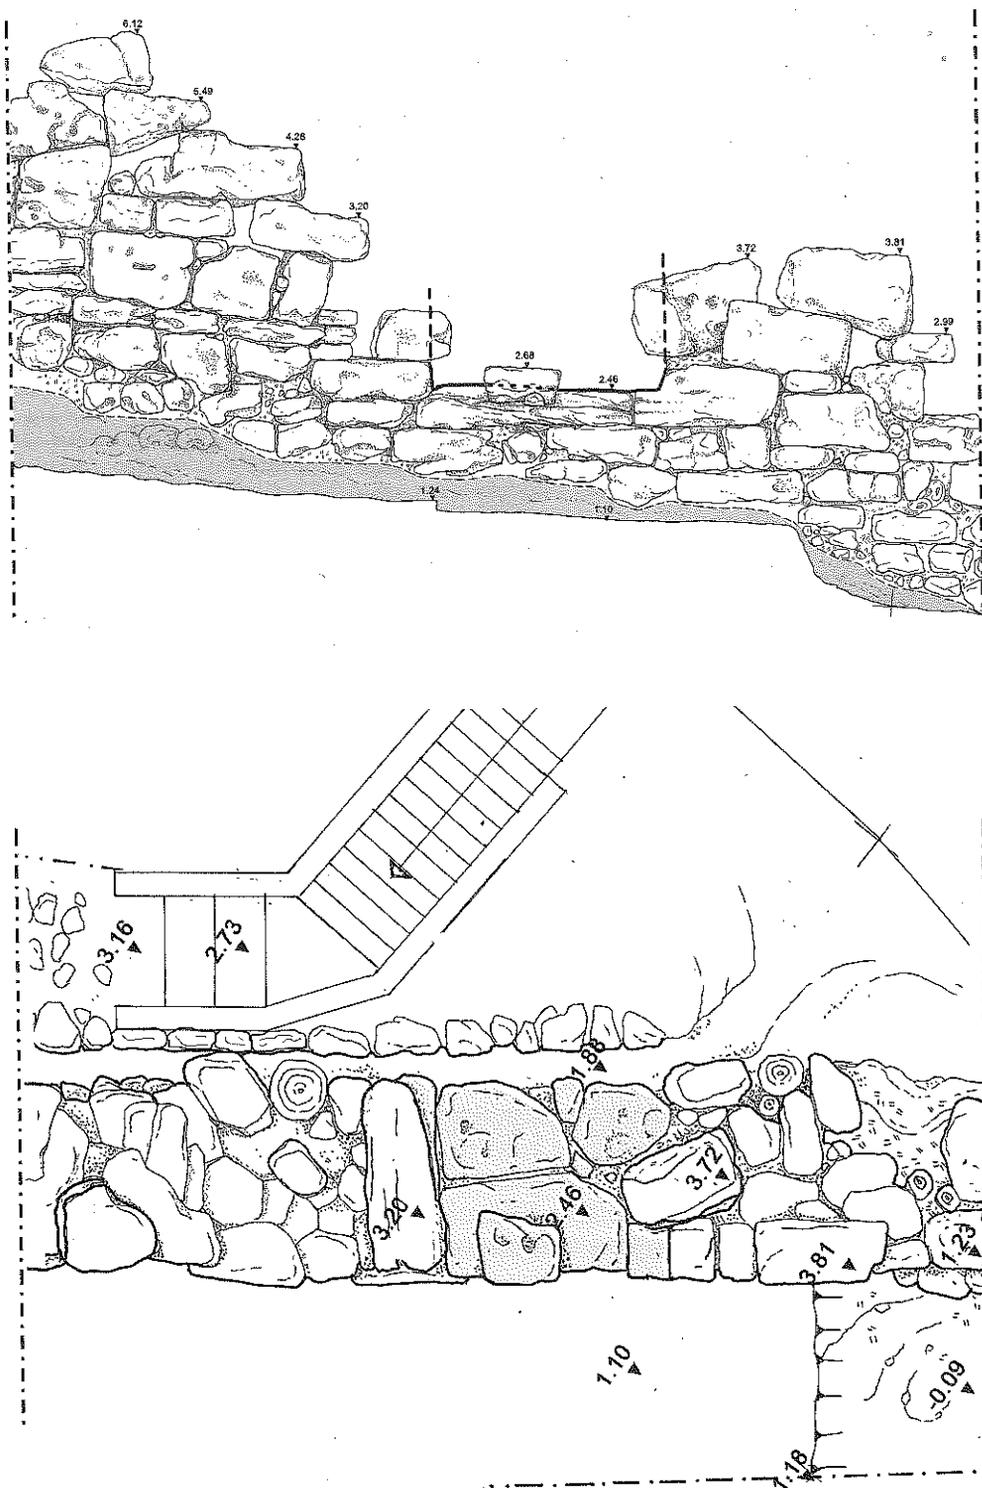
Volterra. Località S. Andrea, mura etrusche: 'postierla', prospetto e pianta (rilievo R. Sabelli, M. R. Galanti).
